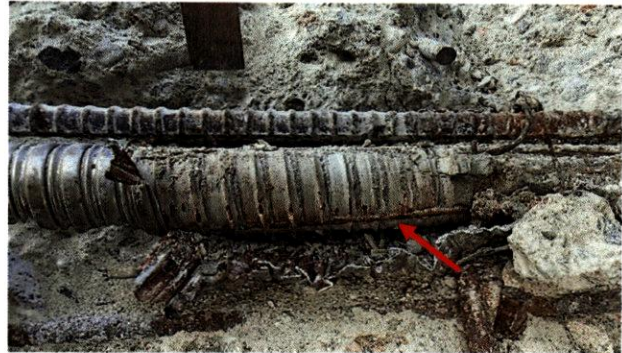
Vista de cerca desde la parte inferior de la abertura de la viga que muestra manchas de corrosión en el exterior expuesto de la lechada (flecha roja) en la muestra F-A-BM-9
